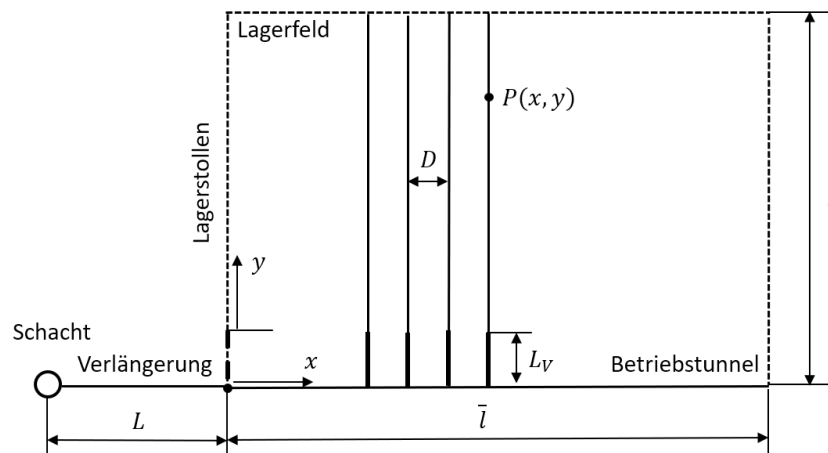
Die für das Netzwerk vereinfachte Anlage mit den BE/HAA-Lagerstollen und dem Betriebstunnel bis zum Schachtfuss mit Verschlussbauwerken
